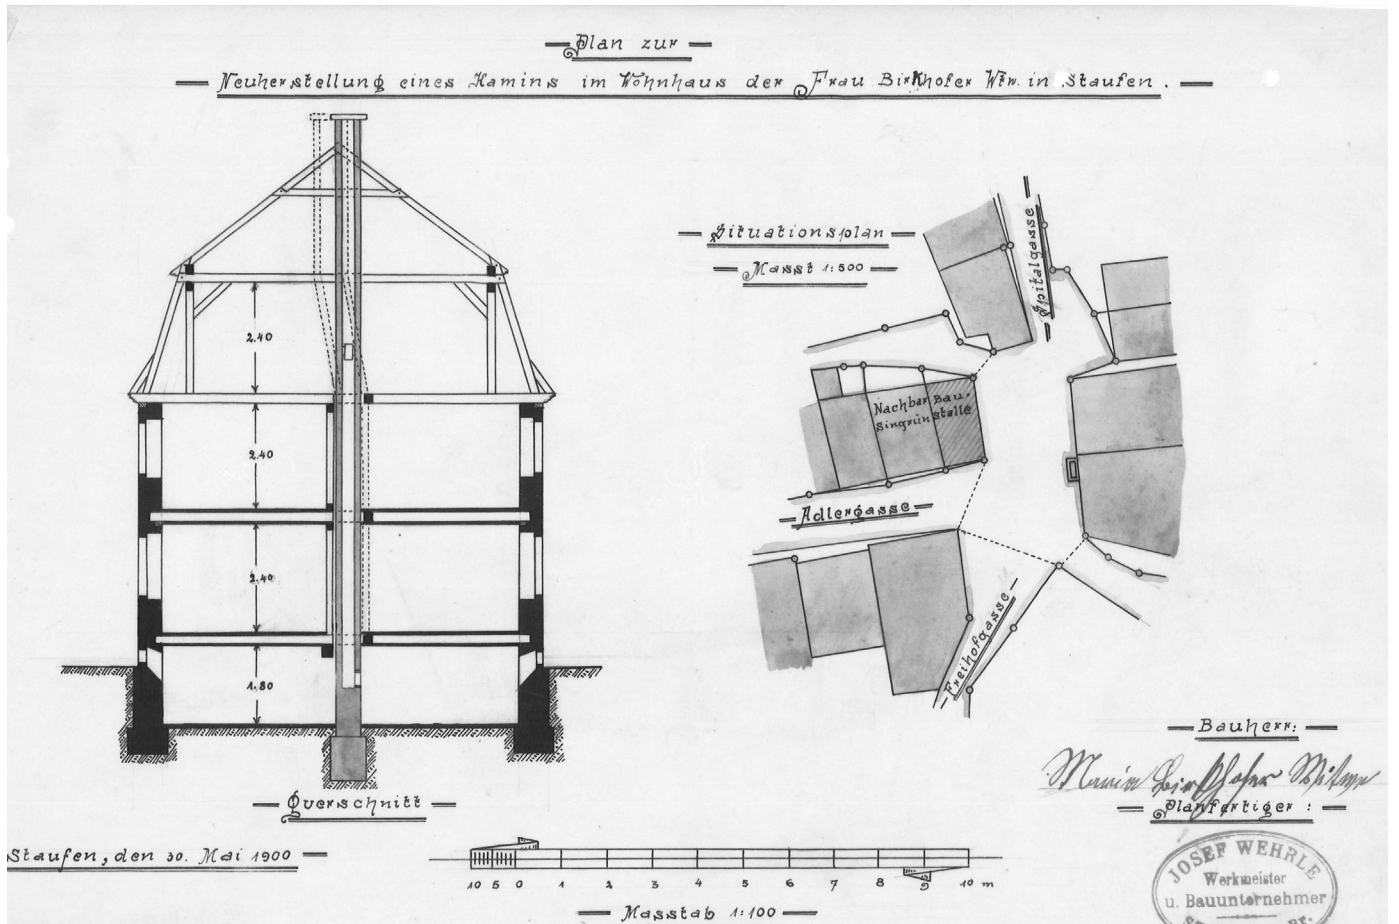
Spitalstraße 1, Lageplan und Querschnitt von 1900.
